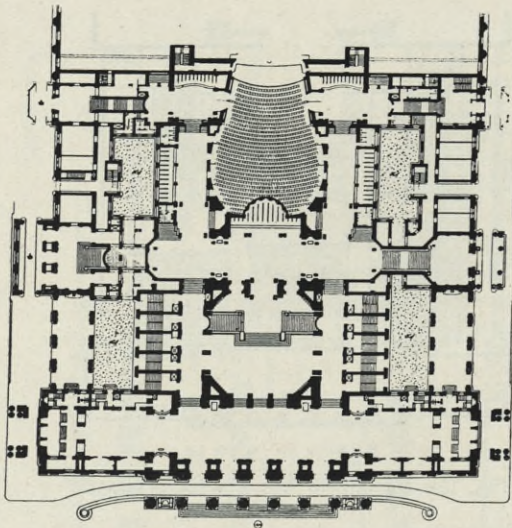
Grundriß des Zuschauerhauses in Höhe des Parketts.
